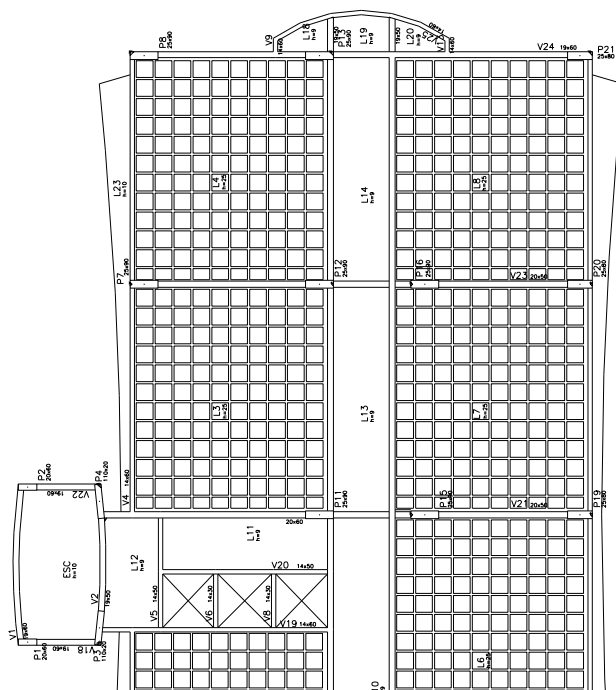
Edifício HC Plaza – Vigas + Lajes nervuradas.
